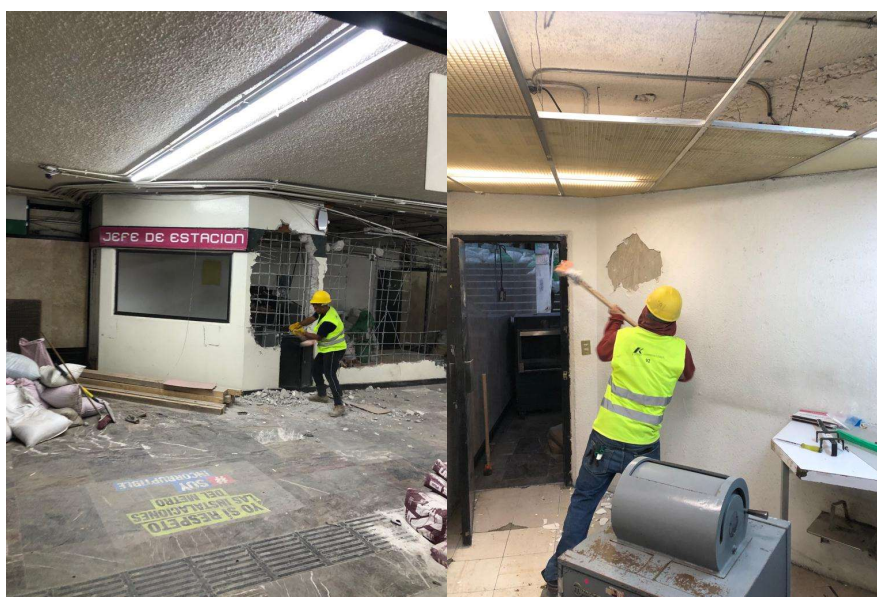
Demolición de muro de concreto armado. Elaborado por el autor.
